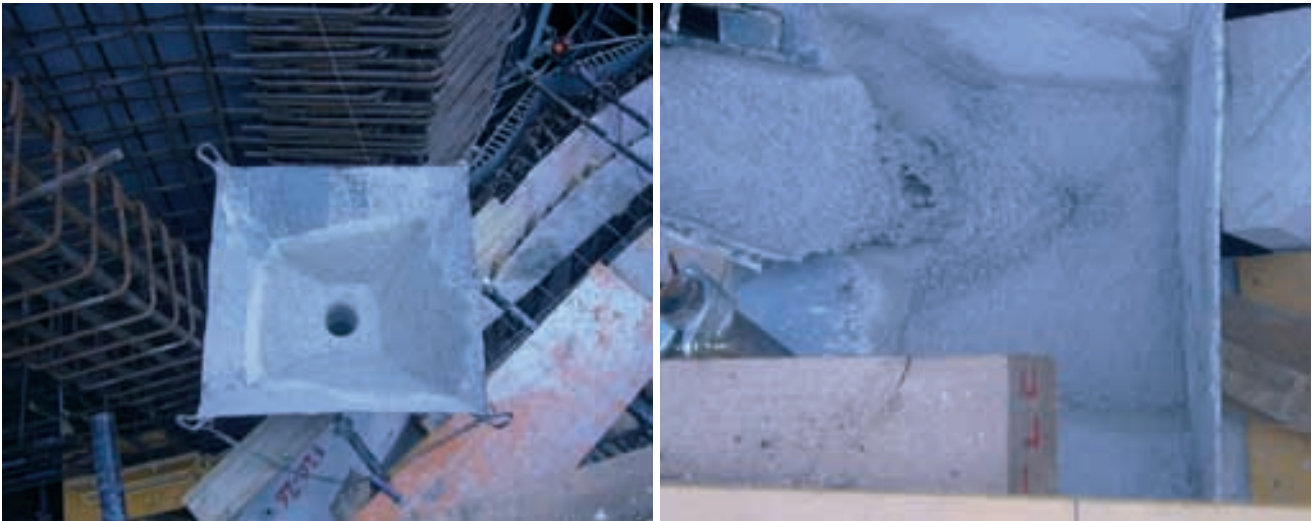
Hormigonado de los muros (a y b). Fuente ATESF
